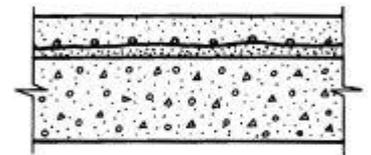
Camada de assentamento com argamassa convencional armada com tela metálica
